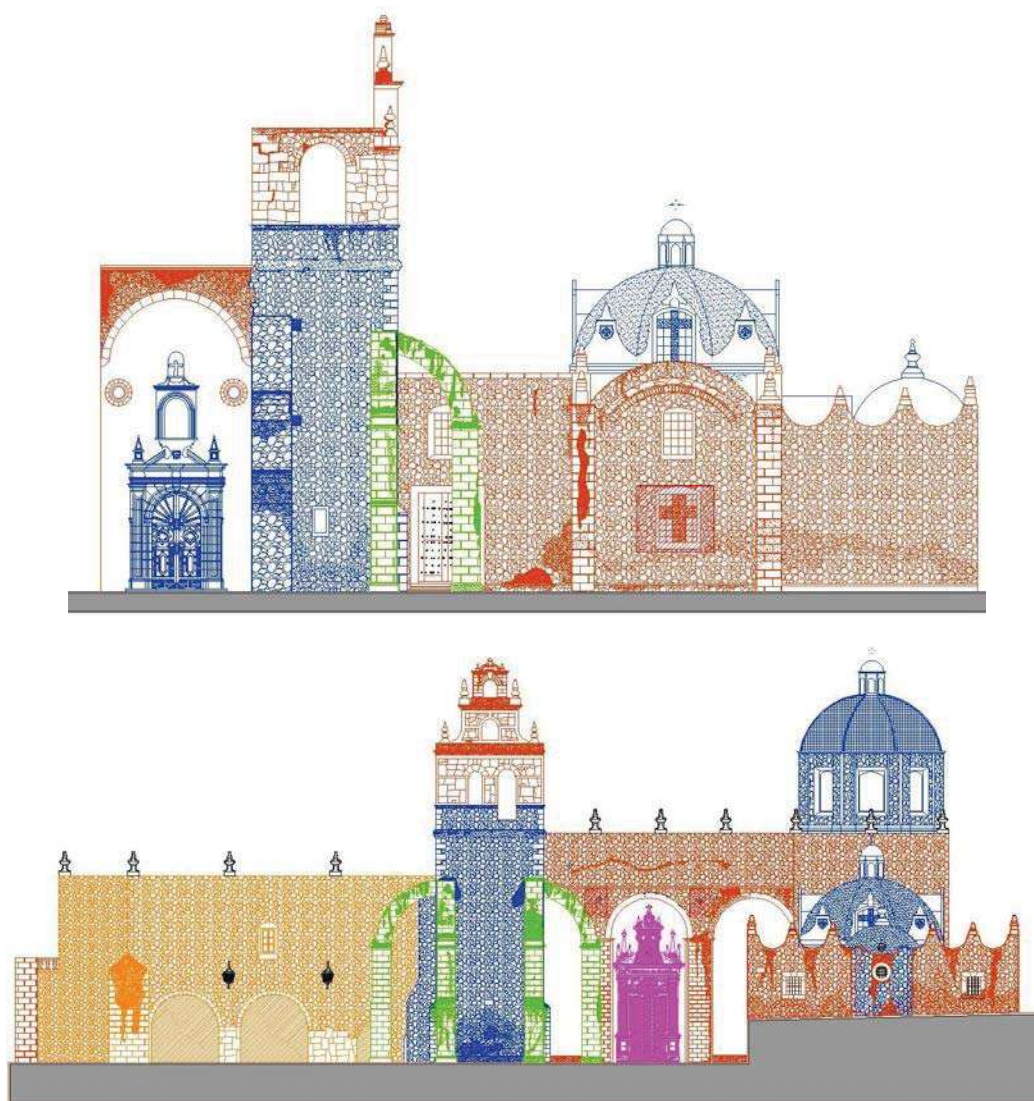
, 29 Fachada principal (arriba) y Fachada lateral (abajo) , Etapas de construcción y modificaciones del Conjunto Conventual de los Carmelitas Descalzos, elaboró Yadira C. Avila
